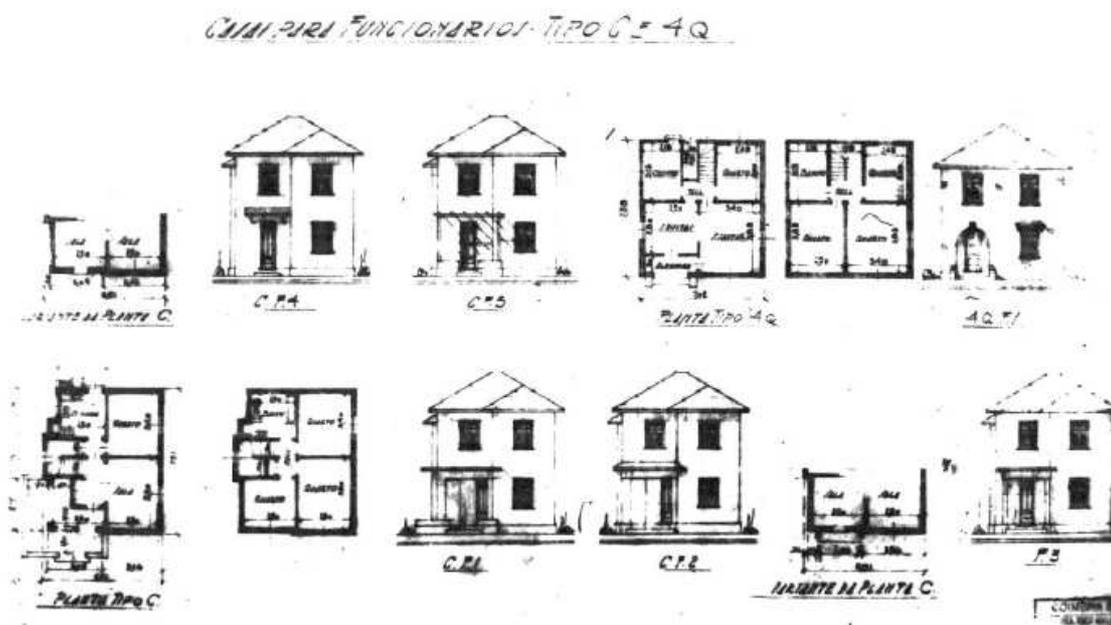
| CASAS TIPO – A MESMA PLANTA DIFERENTES FACHADAS
